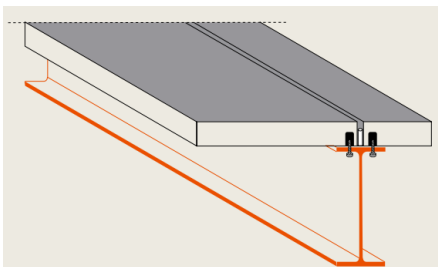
Losa prefabricada fijada al ala superior de la viga.
